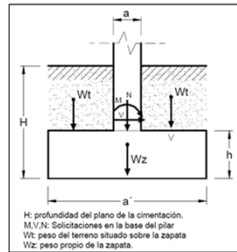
Acciones a considerar en el cálculo de zapatas.
